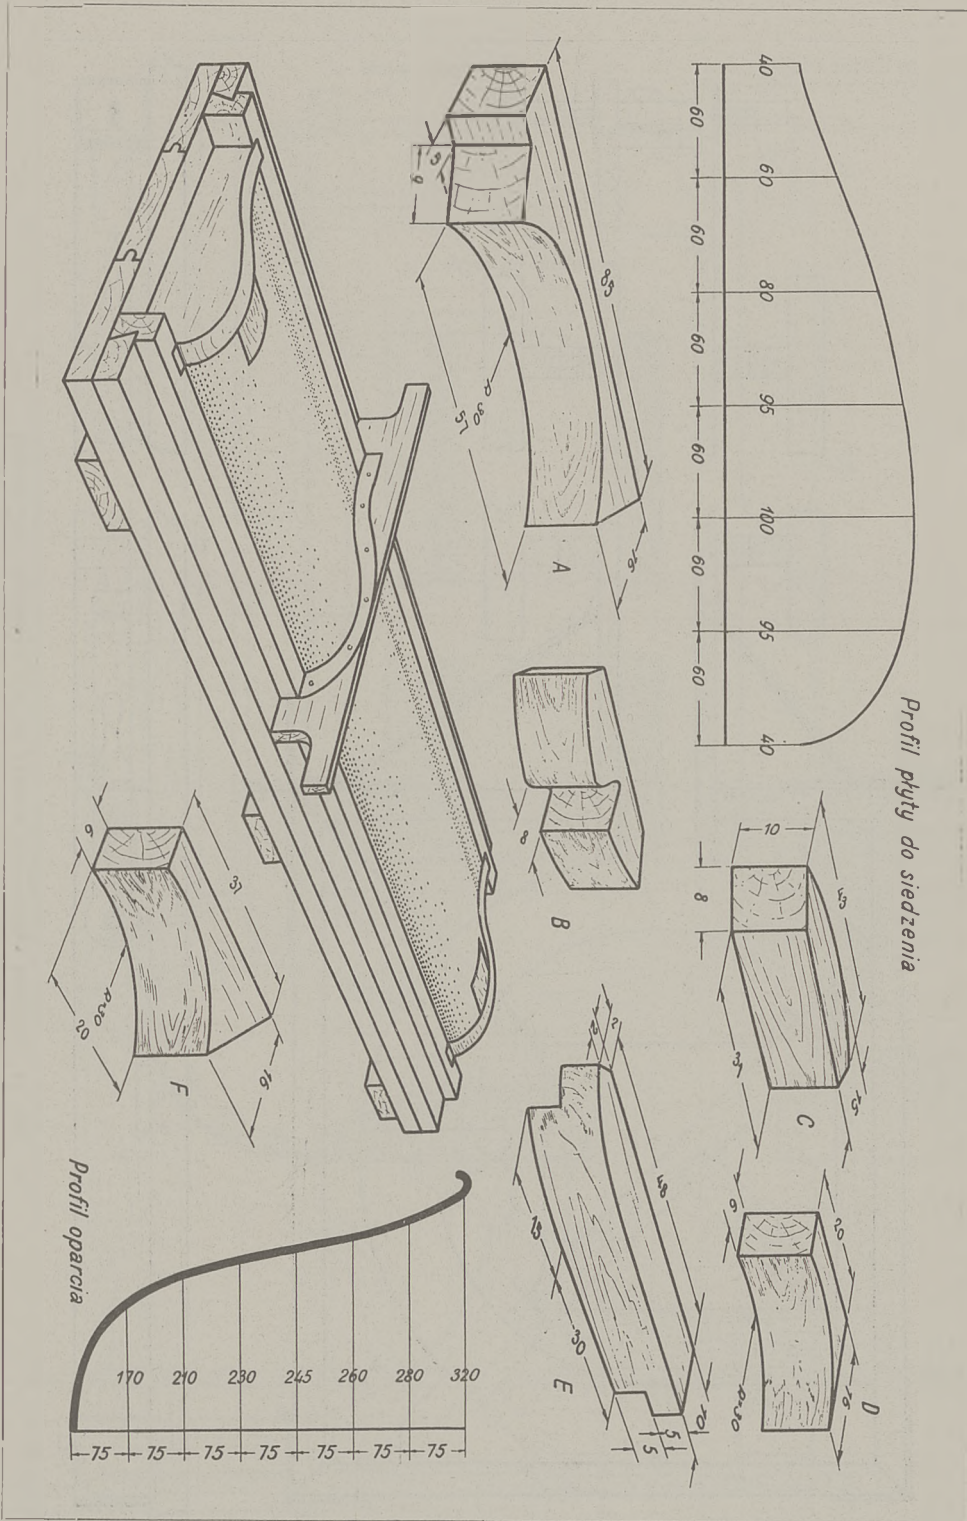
Szczegóły konstrukcyjne, dotyczące betonowej ławki - pergoli.
